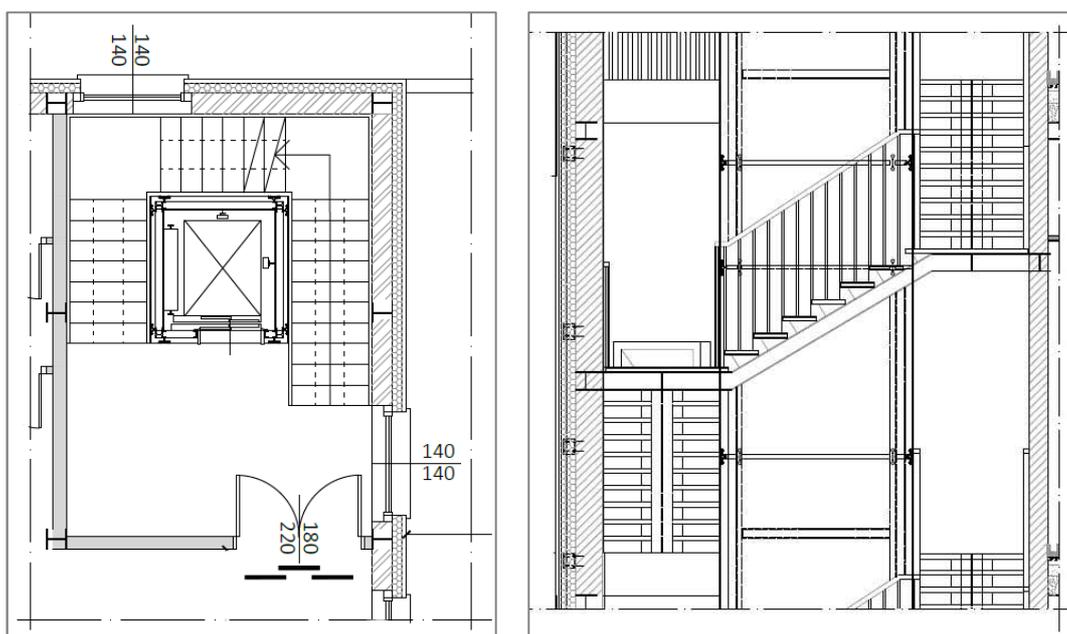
Stralcio in pianta (a sinistra) e in sezione (a destra) del corpo scala e vano ascensore tra Piano Rialzato e Piano Primo. Estratto dalle rispettive tavole in allegato.
